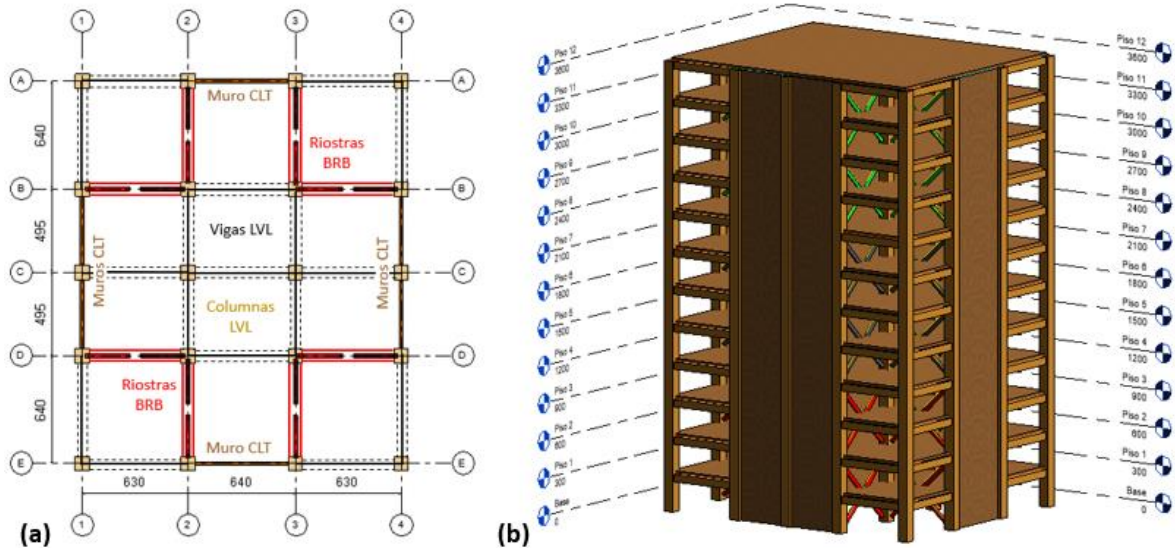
Estructura de estudio: (a) vista en planta; y (b) vista 3D en Revit.
